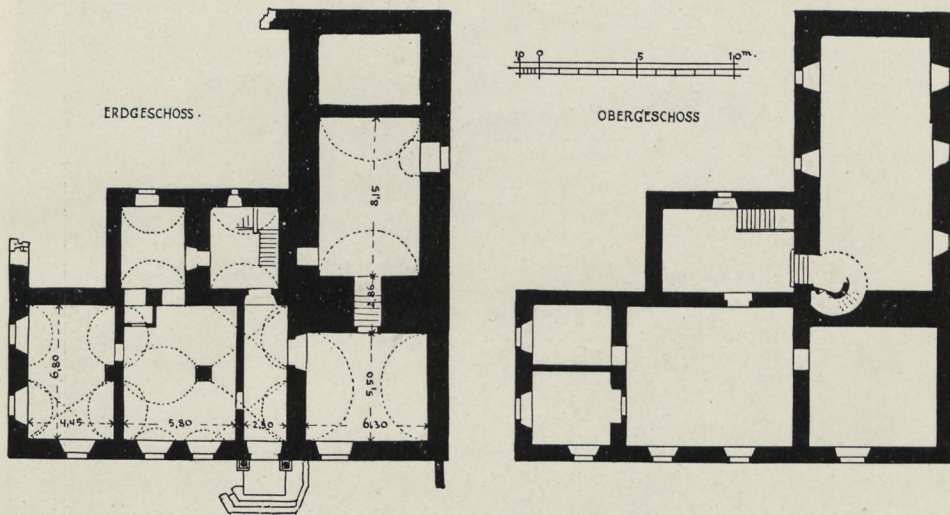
Stein. Grundrisse des Schlosses.
